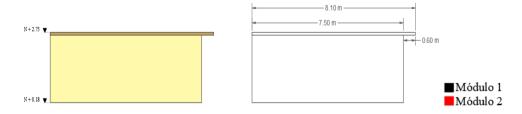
Vista y dimensionamiento de fachada lateral izquierda de la vivienda mínima modular.
